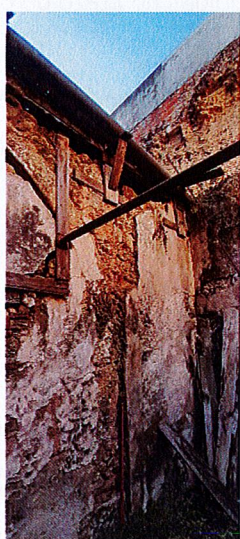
Vista do interior. Destacamentos, fissuração e desagregação das alvenarias
